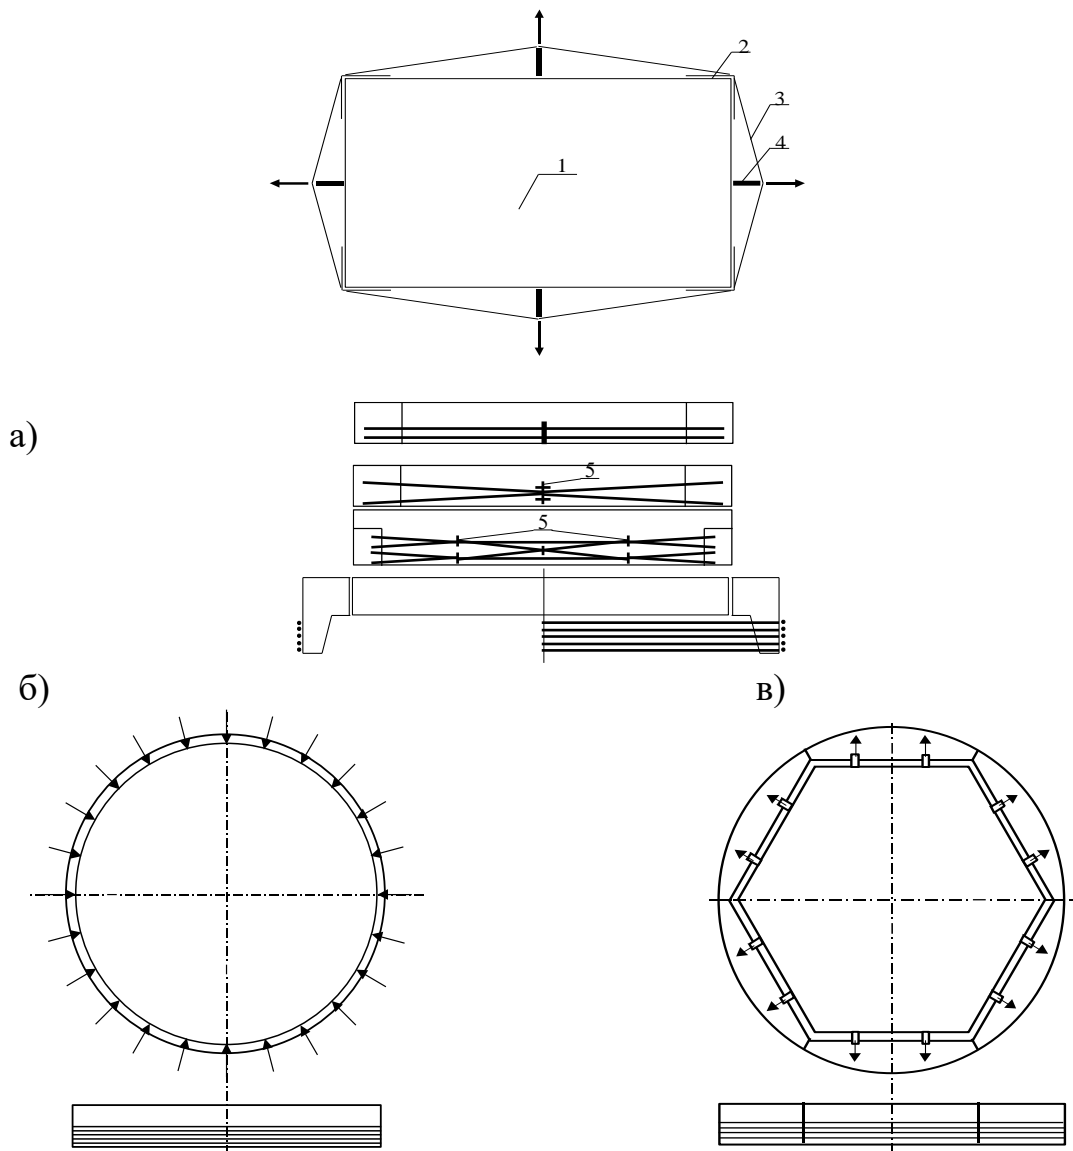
Усиление прямоугольных (а), круглых (б) и многоугольных (в) в плане фундаментов
